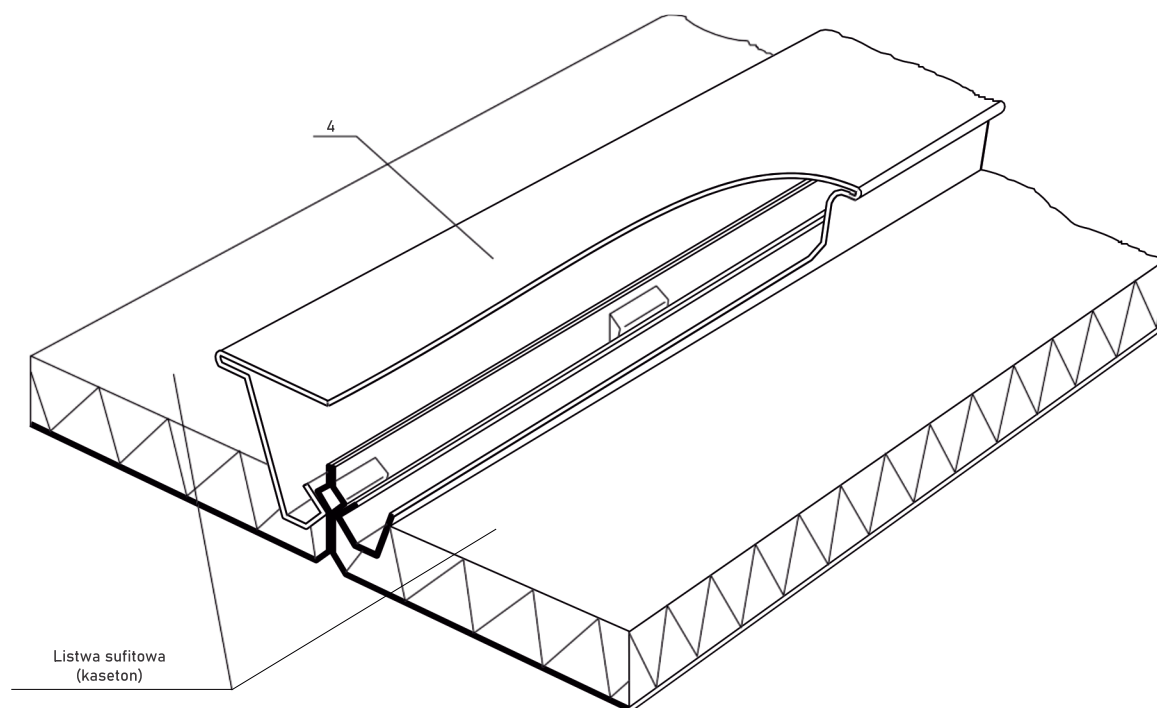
Kierunki montażu płyt sufitowych lub listew i płyt sufitowych
